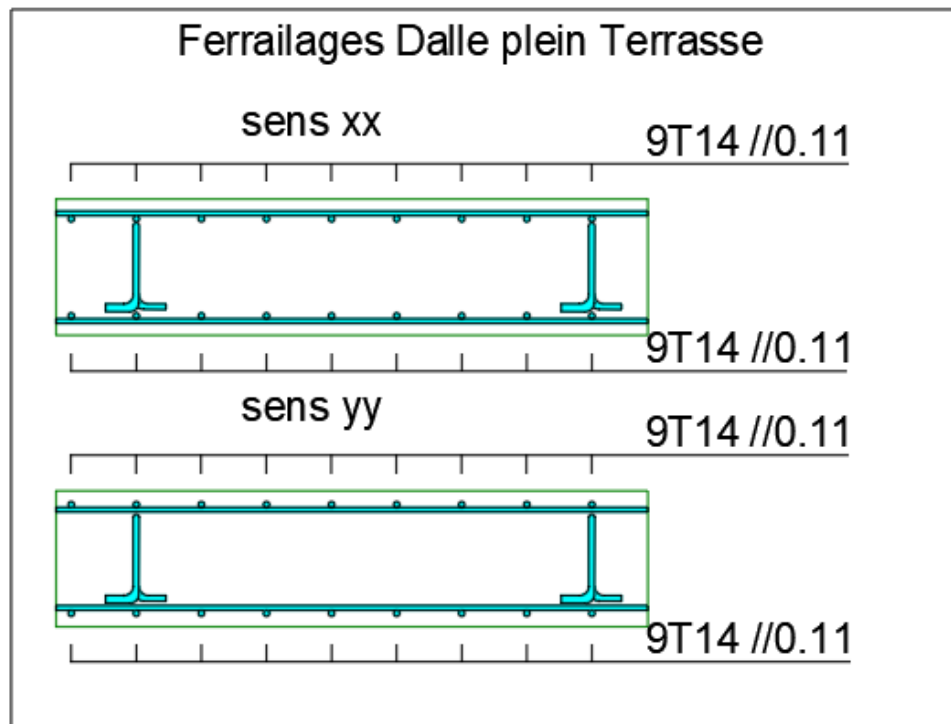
Schéma de ferrailage pour la dalle Terrasse.
